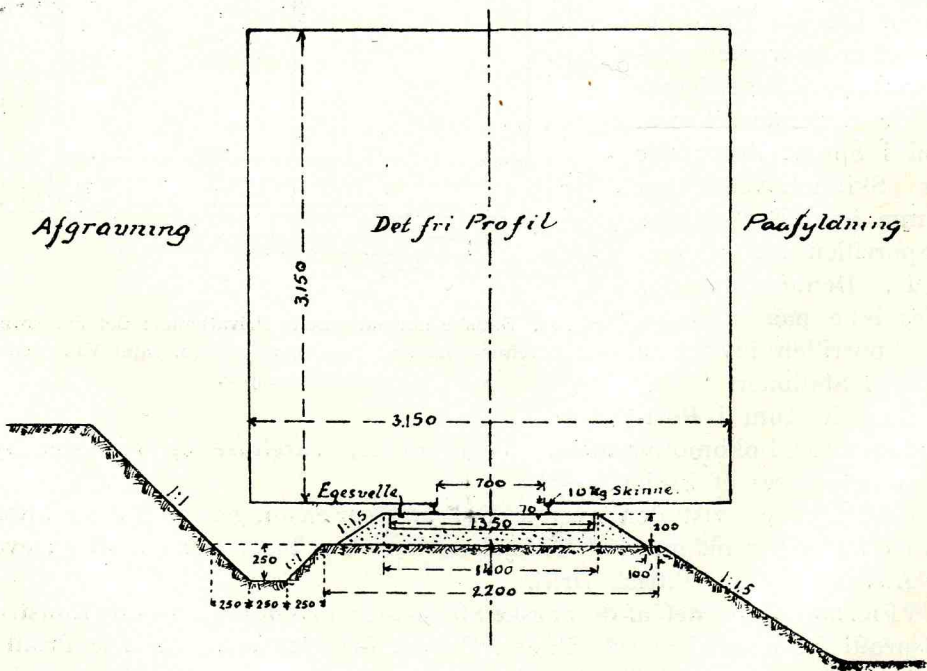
Det frie Profil for Damproebaner paa Lolland.
